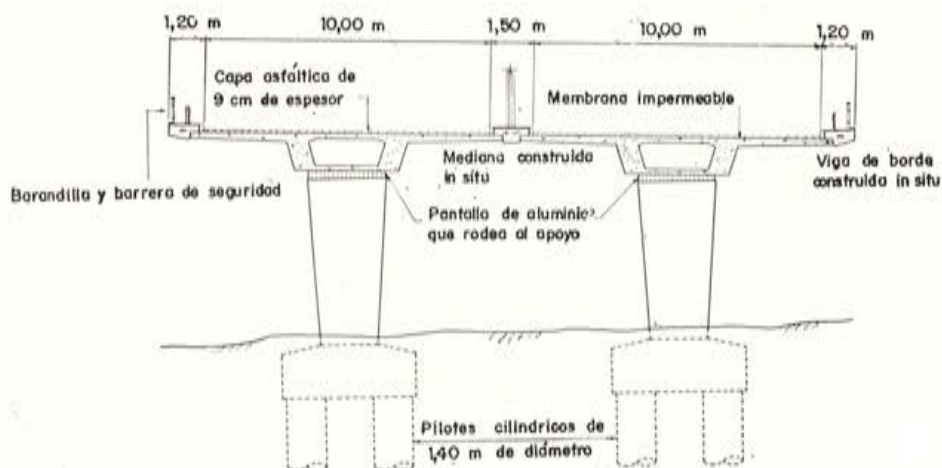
Paso elevado de Mancunian Way, en Manchester. Sección transversal de la estructura con doble calzada de tres carriles.
